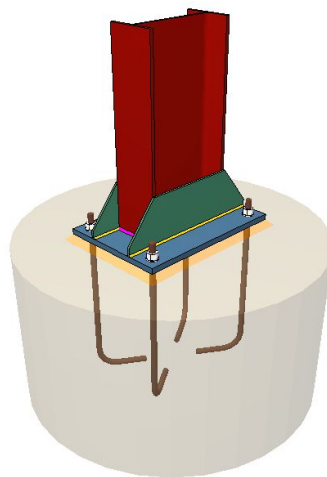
Anclaje de los pilares esquineros correspondientes a los pórticos de fachada
